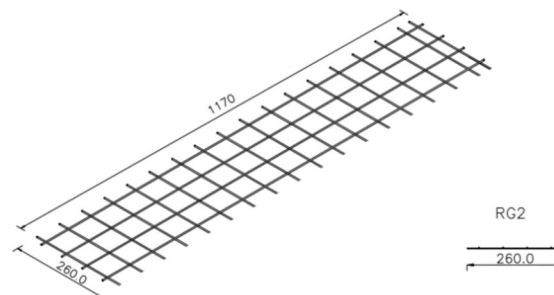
Malla de refuerzo tipo RG2 - Emmedue, 2008.
